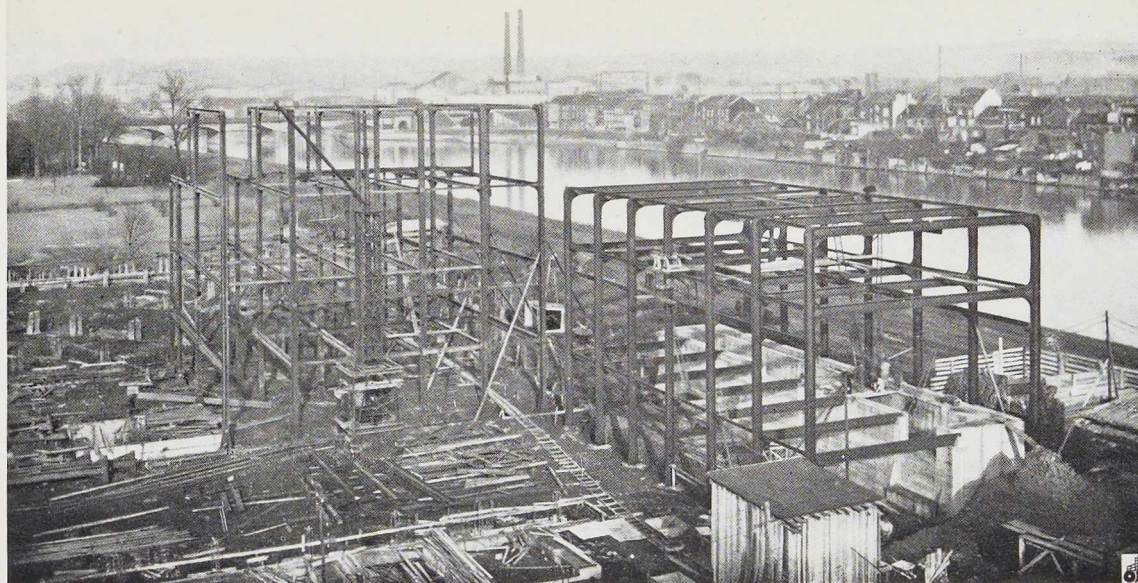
Chantier des instituts universitaires du Val-Benoît.
